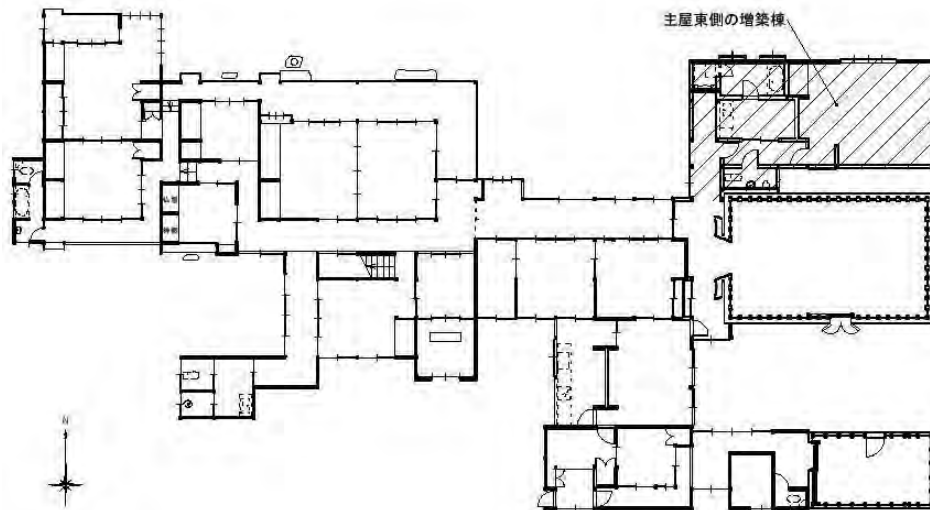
昭和 57 年増築工事後（～現在）の主屋平面図
